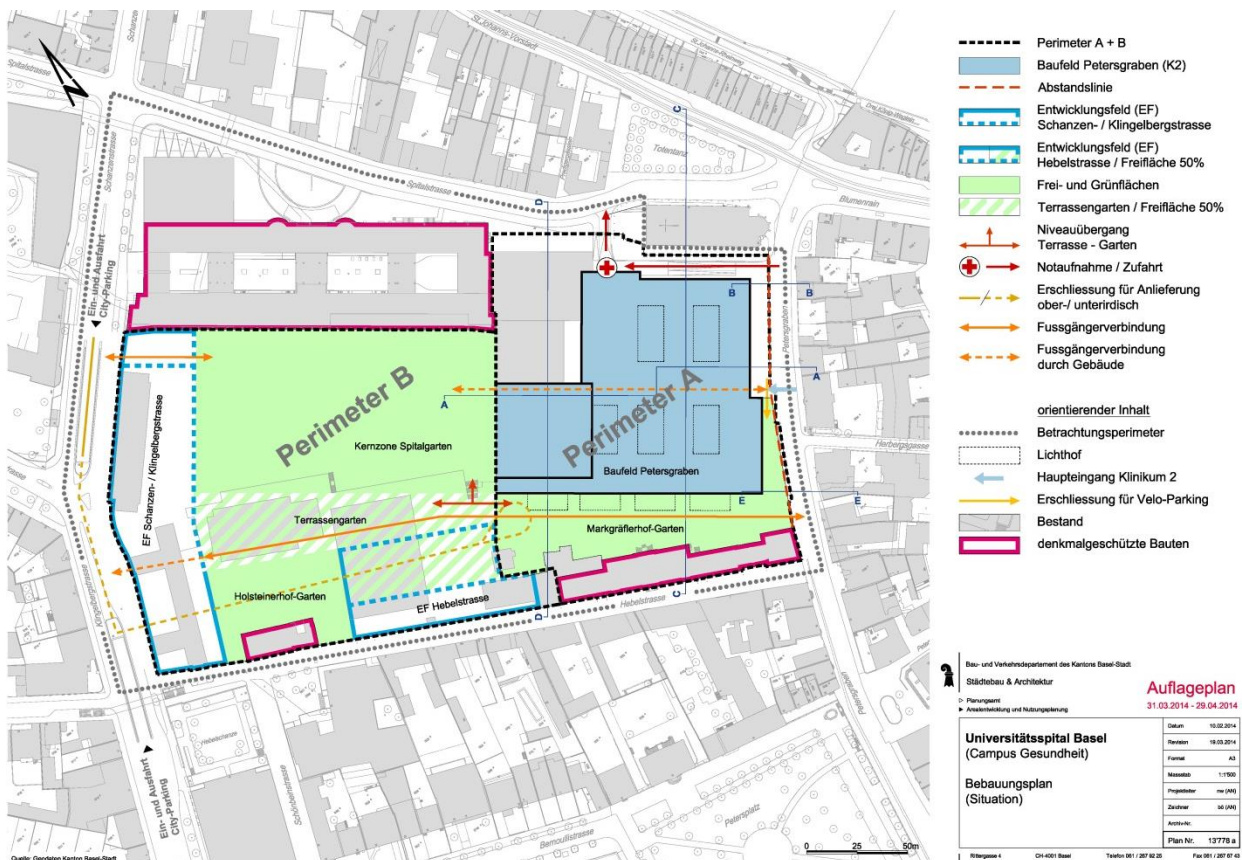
Neuer Bebauungsplan (Plan-Nr. 13'778 a)
